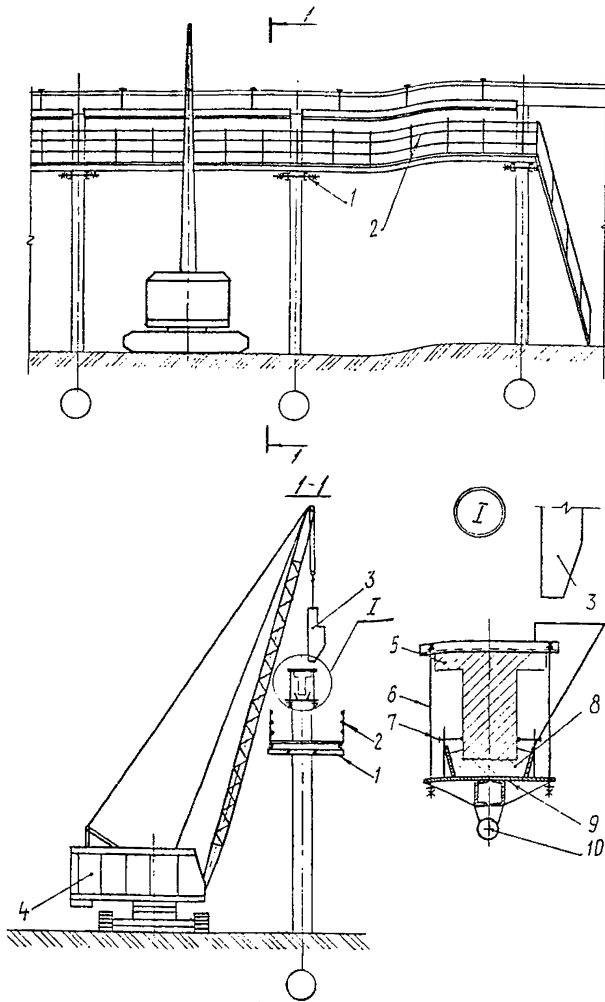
Схема усиления подкрановой балки с креплением рабочих площадок на металлических консолях:
